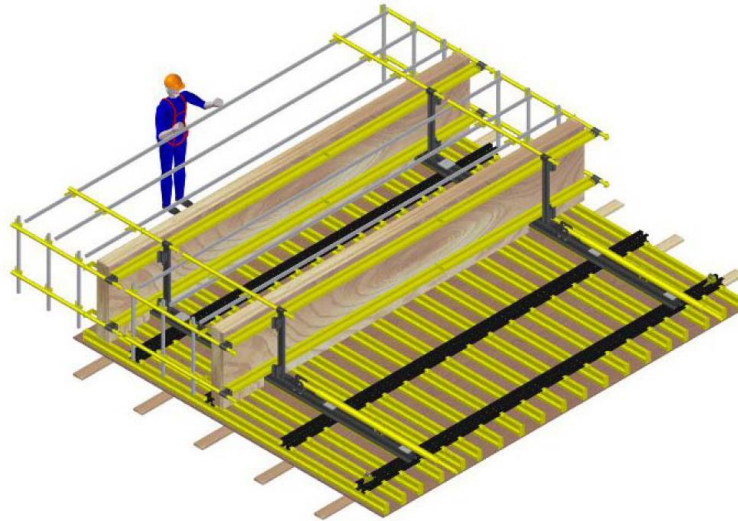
e. Colocación de ménsula, pies de barandilla y rodapiés. Recuperado de: Ulma Construction, *Instrucción técnica de montaje.
